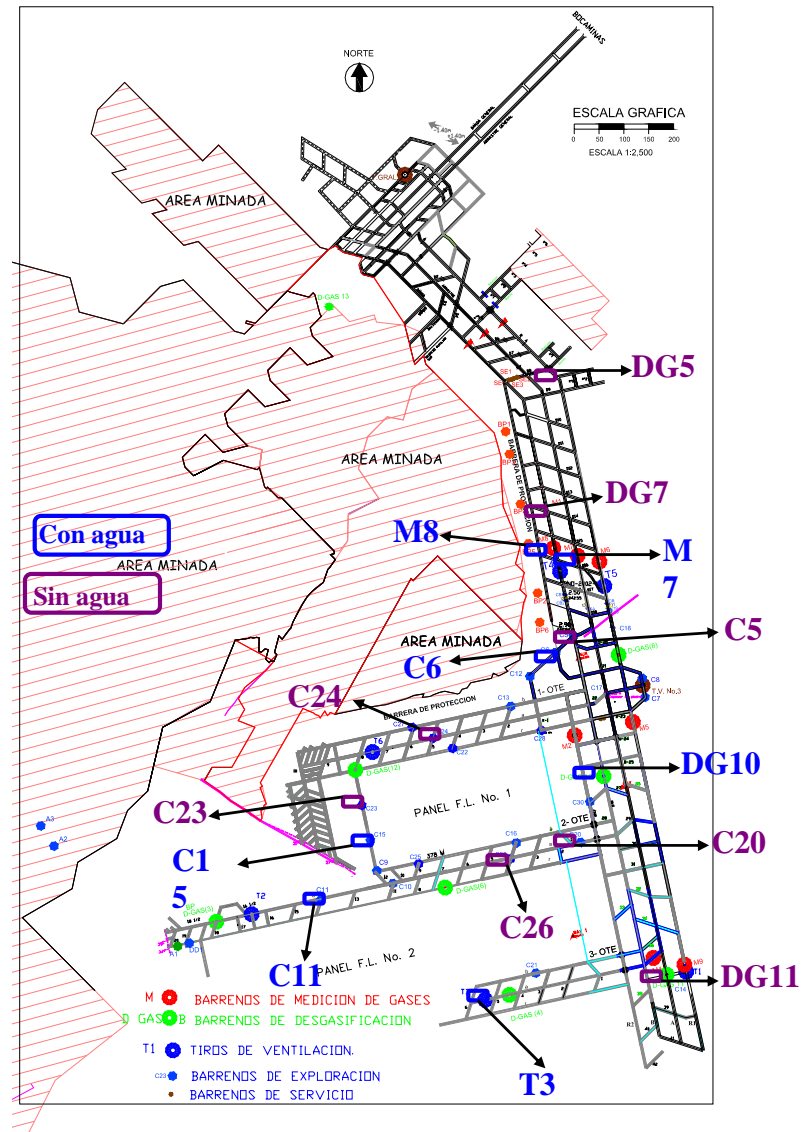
Vista de planta general de la mina que muestra la ubicación de los barrenos.
